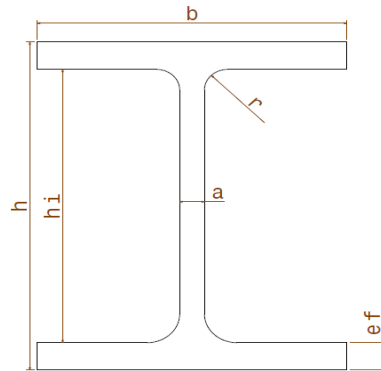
Poutrelles HEB 320 et IPE 400 utilisées pour la fabrication des semelles des tronçons en té
